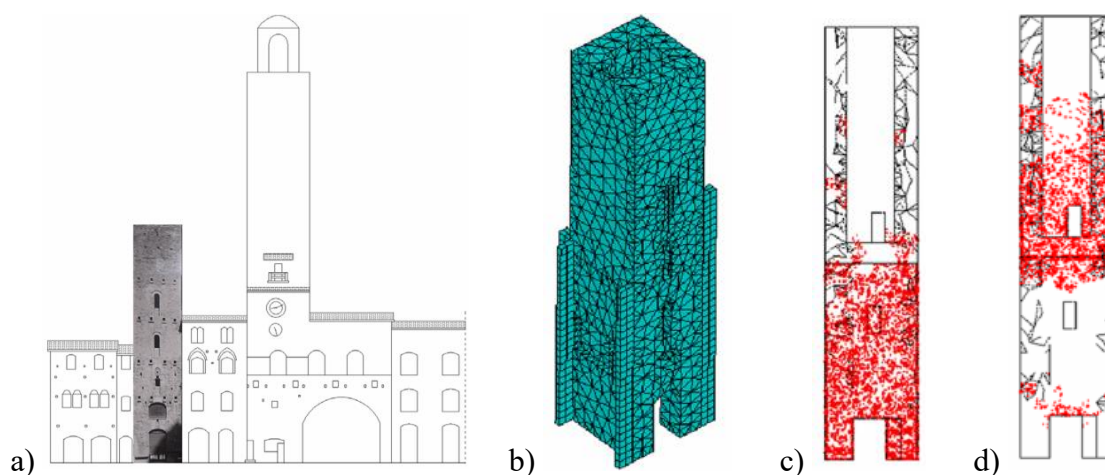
Padrões de deterioração em uma torre sineira devido a forças sísmicas, a) vista frontal e interação da torre com outros corpos adjacentes, b) modelo com EF isolado e com restrições laterais, c) zona de fissuração em uma torre isolada, d) zona de fissuração em uma torre lateralmente restrita. Recuperado de: Gianni B., et. al.
